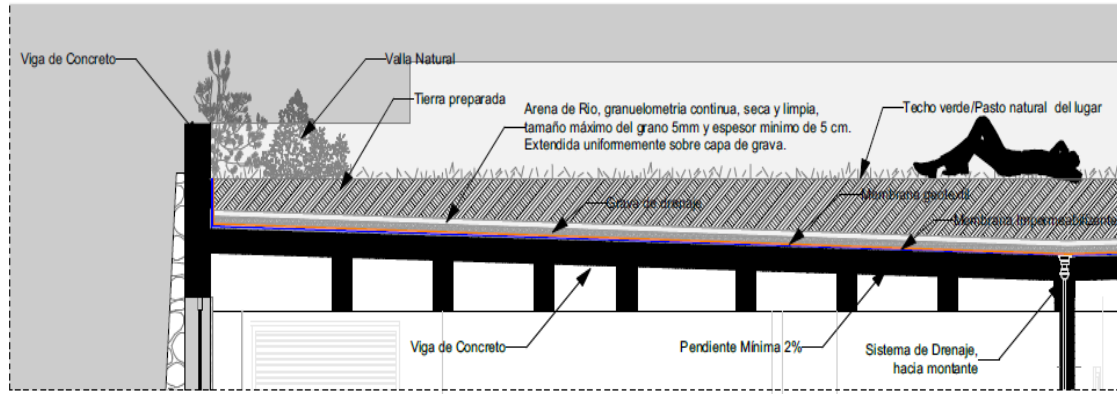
Detalle constructivo Cubierta verde propuesta Centro de Visitantes Huchuy Qosqo.
